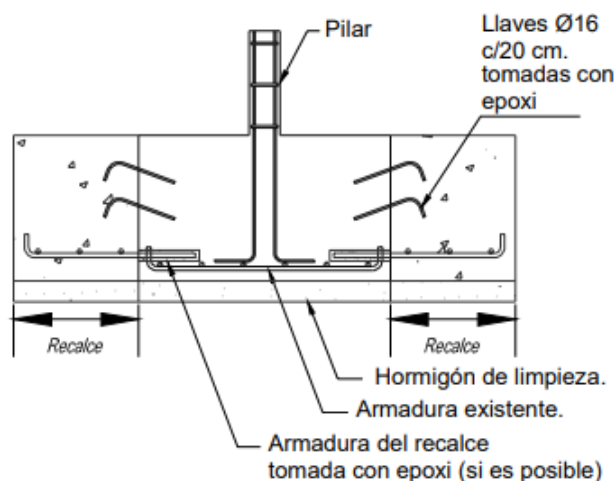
Pérez J. Técnicas básicas de recalces. Unión armadura cimentación existente a nuevo encepado
